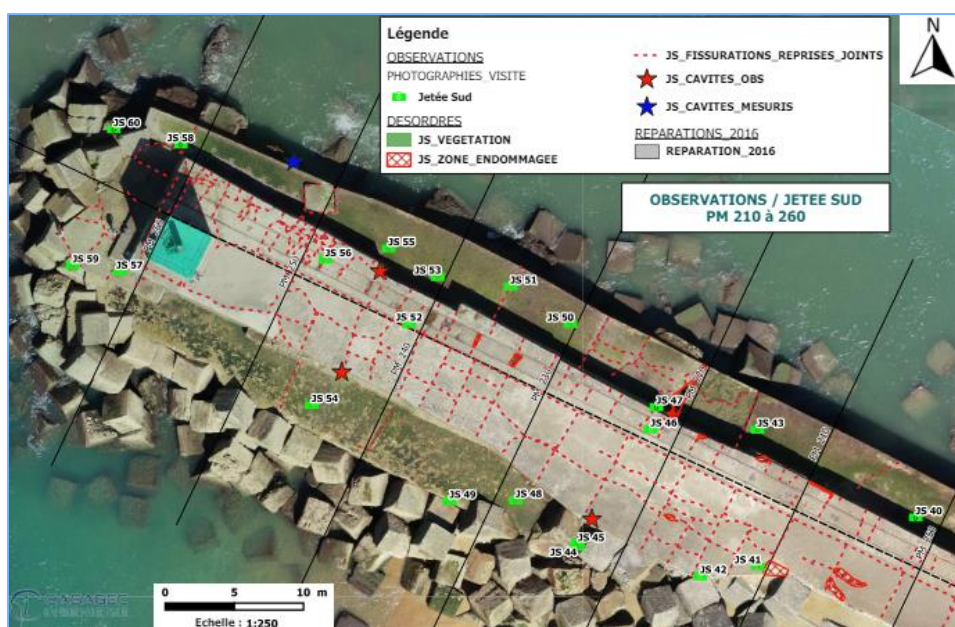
Repérage des fissures de la dalle de couronnement par Casagec
